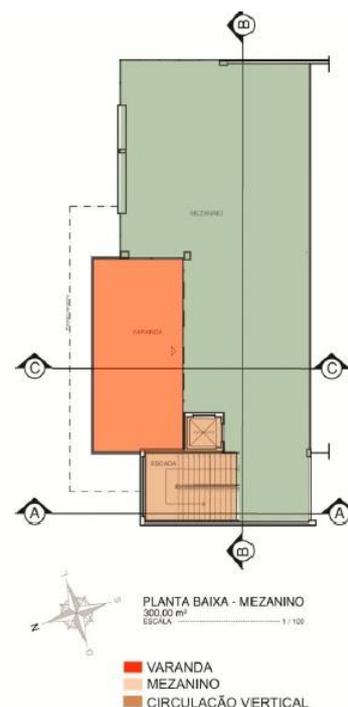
Planta baixa mezanino, do terminal de passageiros
